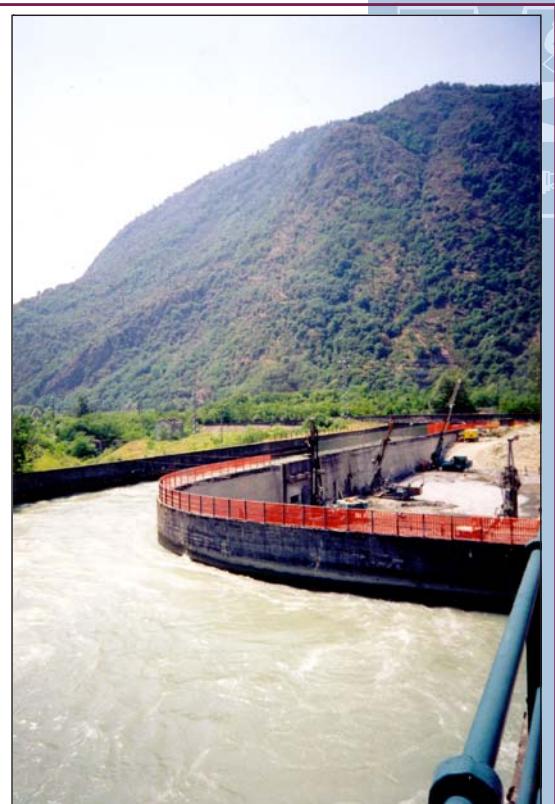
Строительство четырехочкового гидротехнического тоннеля-сифона в регионе Ломбардия. Выполнение грунтоцементных свай-колонн ограждения и веерных анкерных свай крепления котлована вблизи отведенного канала.
